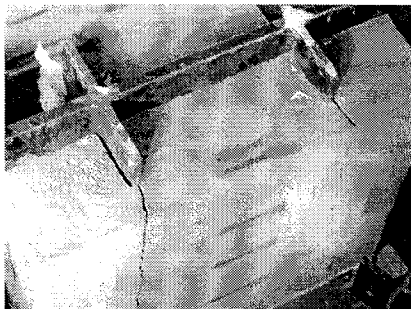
ひび割れの様子 (S.D-B50-L300-H100)
